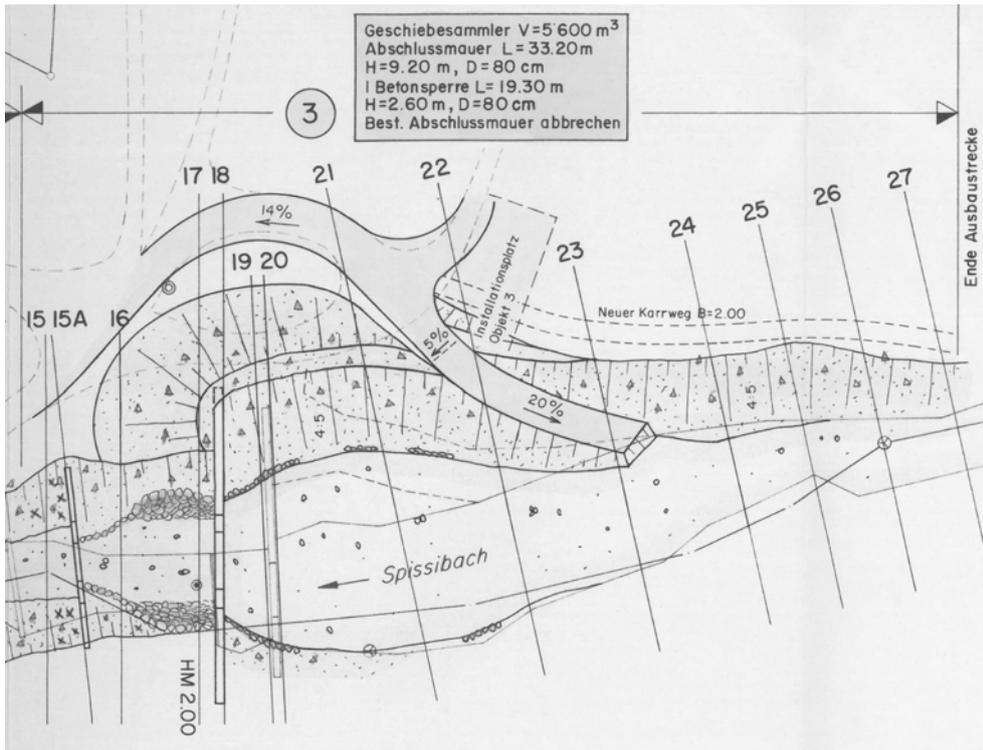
Grundriss Bereich Geschiebesammler Spissibach mit Auslaufbauwerk bei Profil 18 (aus Spissibach, 1996).
